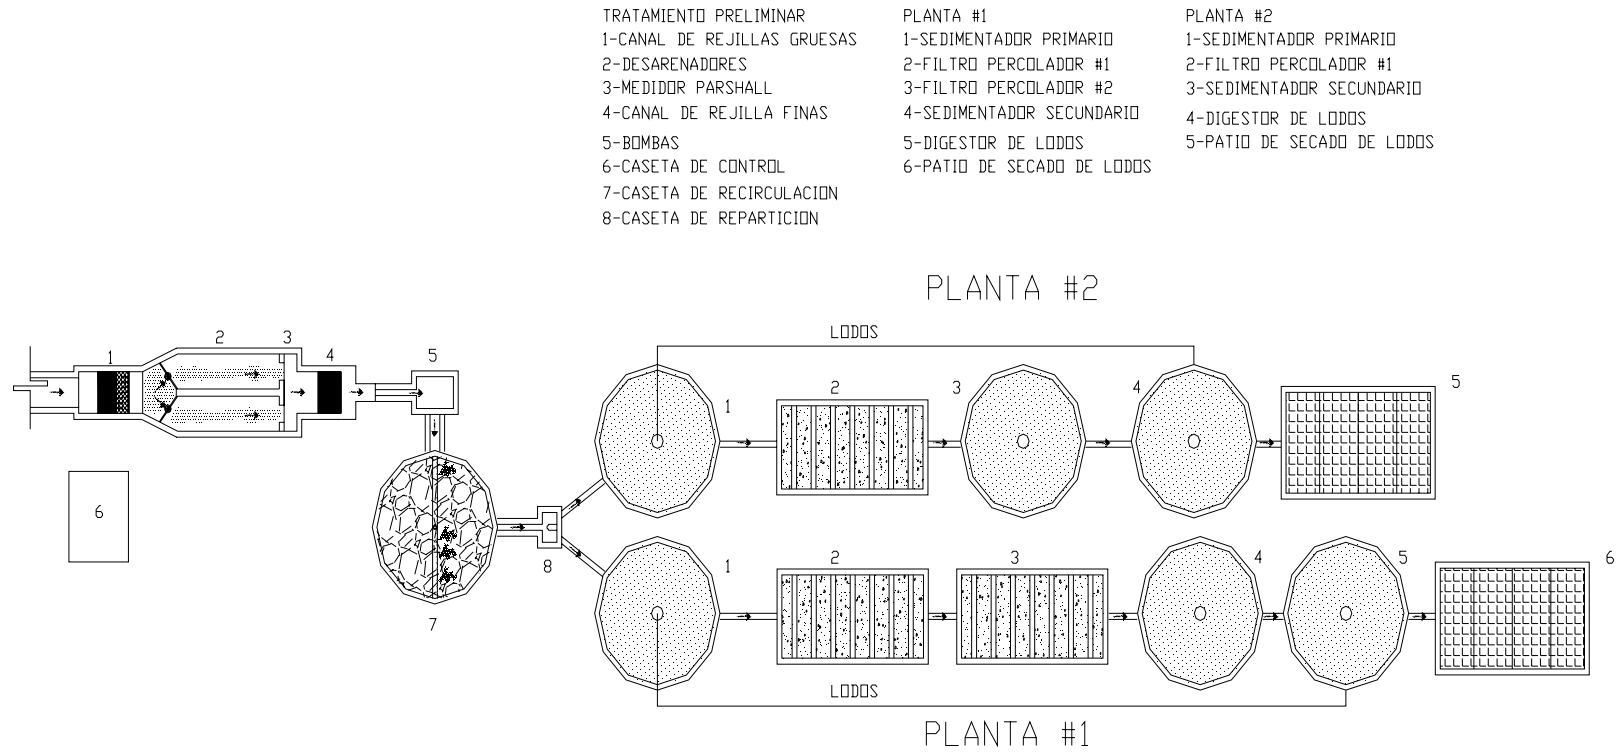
Esquema de la planta de tratamiento de la Urbanización Alta Vista I y II.
